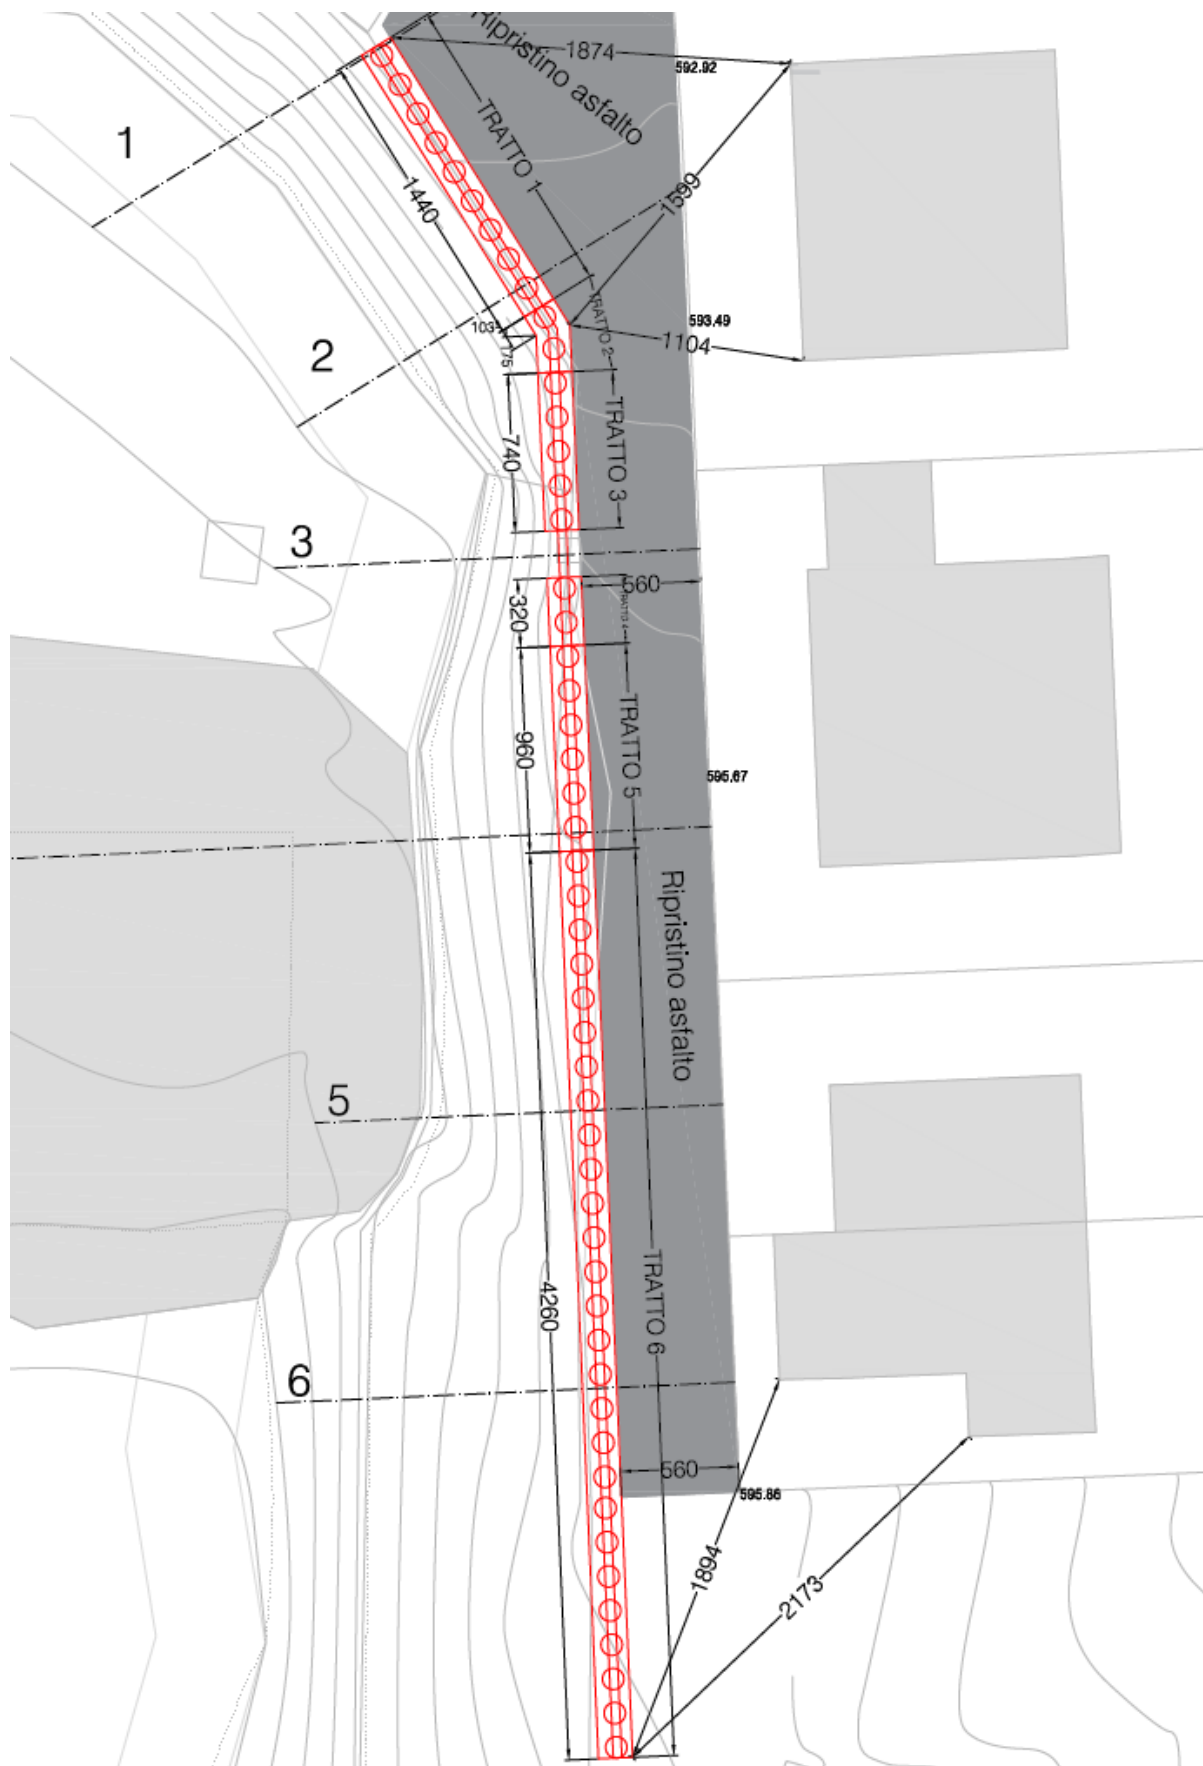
Planimetria struttura via Umberto Giordano
